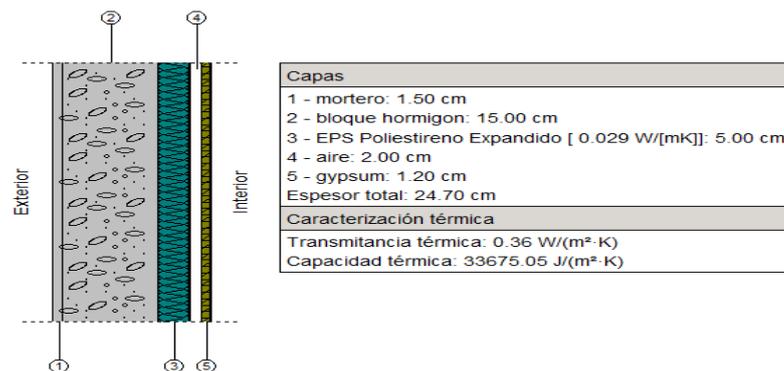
8 Caracterización mampostería con gypsum y aislante
